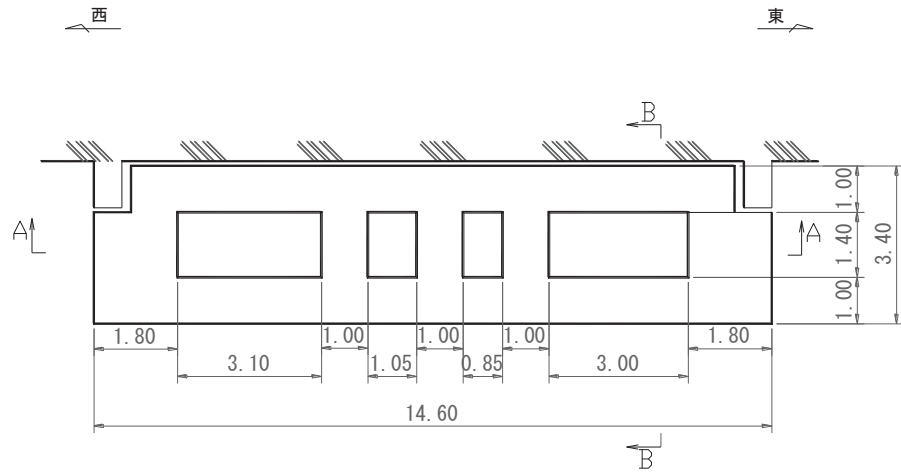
第 3 号機補機冷却海水系放水ピット平面図 (D-D 断面)
